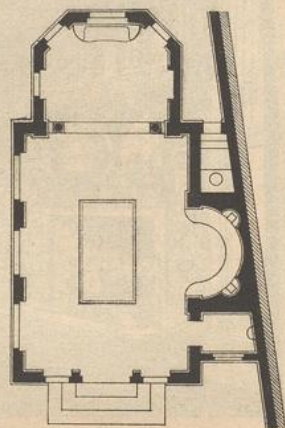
¹²⁴⁾ giebt den Grundriß des Billardzimmers in einem englischen Landhause. Es bildet die äußerste Ecke des Hauses und ist von einem Flurgange aus unmittelbar zugänglich. Neben dem Zimmer sind ein Wafchraum und ein Spülabort untergebracht.
